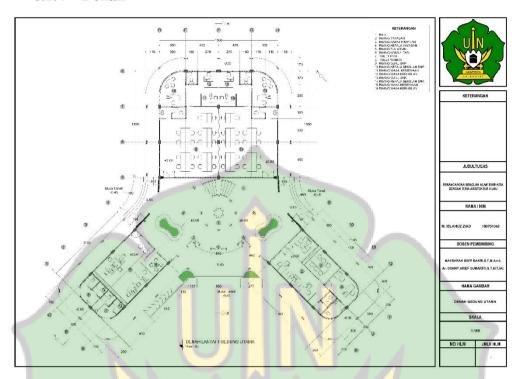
3 Site Plan Sumber: Dokumen Pribadi
